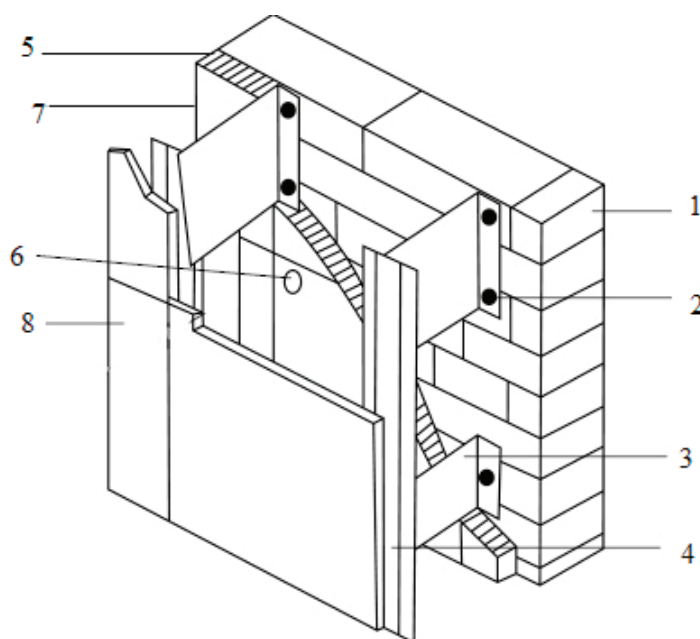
Конструкция вентилируемого фасада: 1 — несущая конструкция; 2 — анкер; 3 — кронштейн; 4 — несущий профиль; 5 — теплоизолирующий материал; 6 — фасадный дюбель; 7 — вентилируемое пространство; 8 — облицовочный материал
